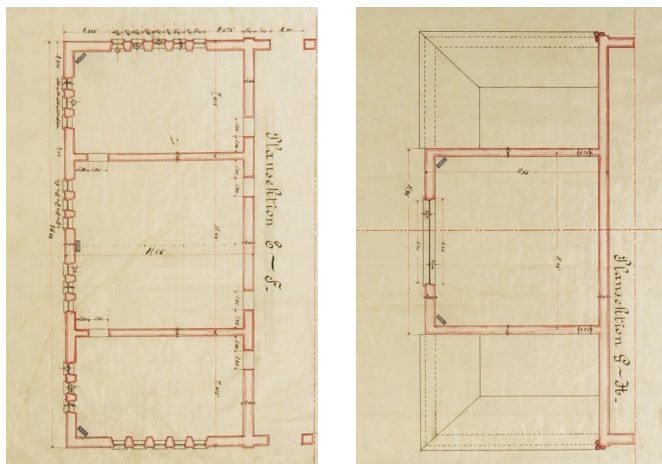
Ritning visande den västra gavelns våningsplan. T.v. plan 1 och t.h. plan 2.. Trol. 1890-tal. Källa: SSA
